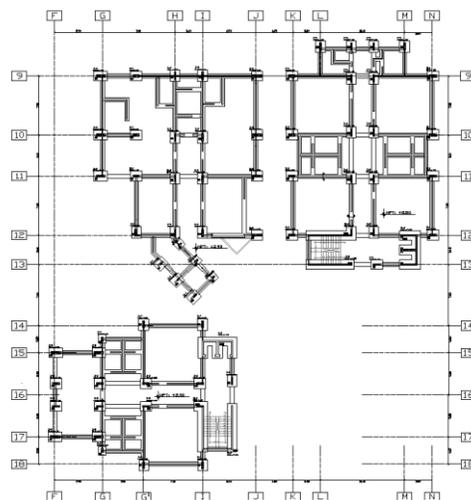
Plano de cimentación de primer piso sector 1. Fuente Elaboración propia
